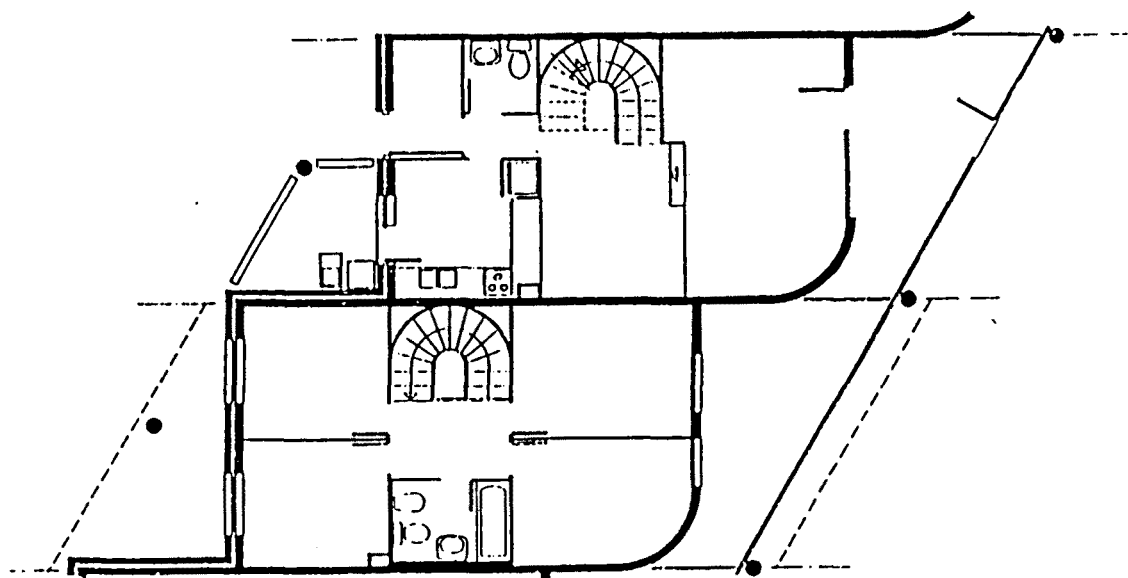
Plano de las casas de tipología invernadero. Arriba, acceso norte; abajo, acceso sur.
